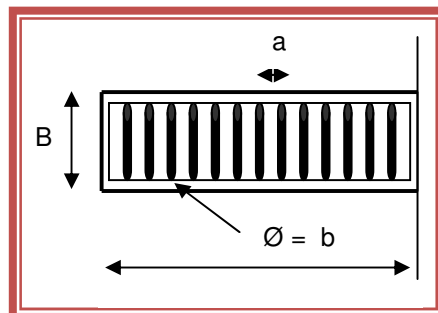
Rejilla – Planta (adaptado por López Cualla).
